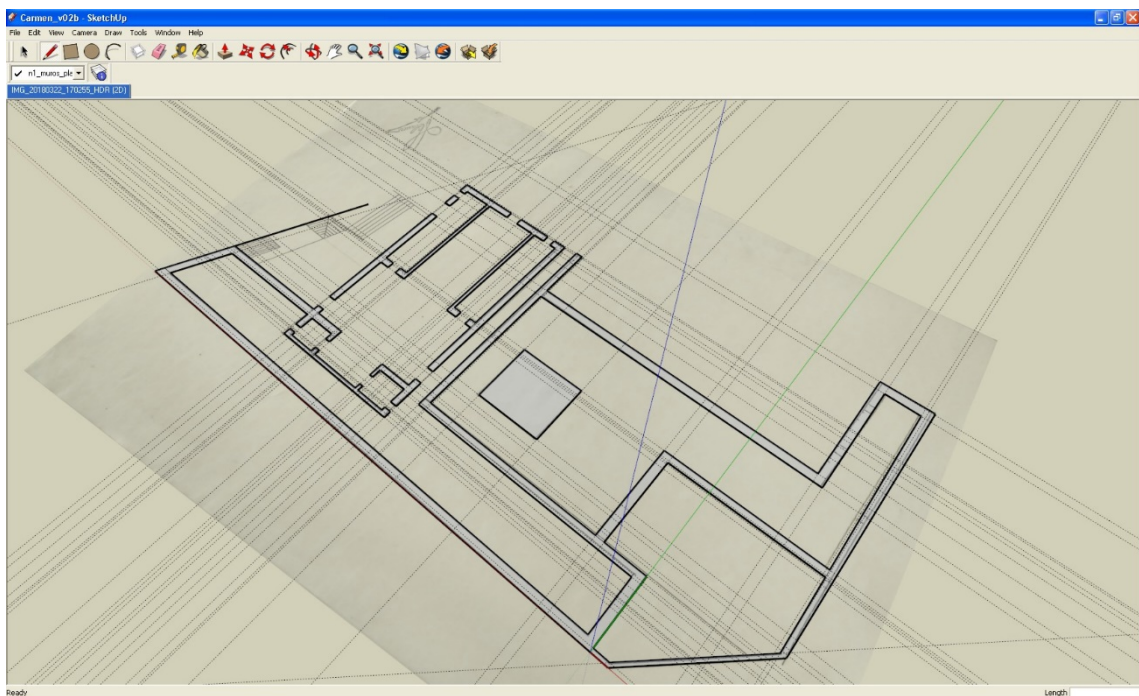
Dibujo completo de los muros sobre la planta rectificada.
